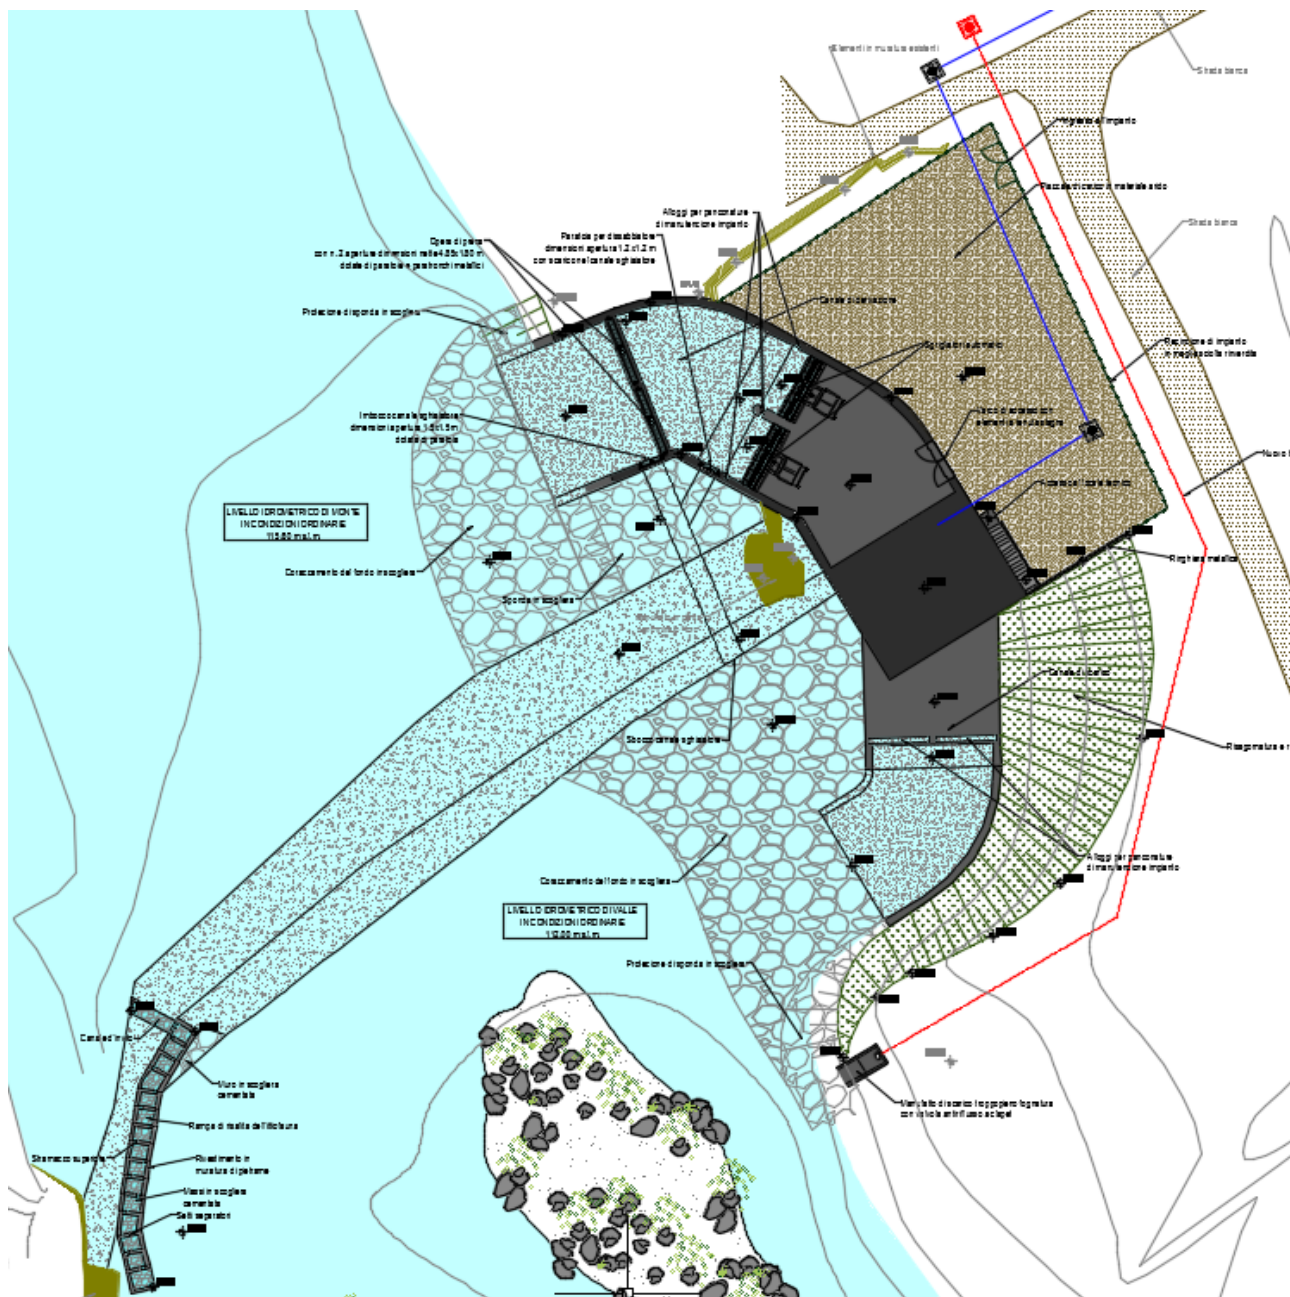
PLANIMETRIA DI PROGETTO GENERALE
